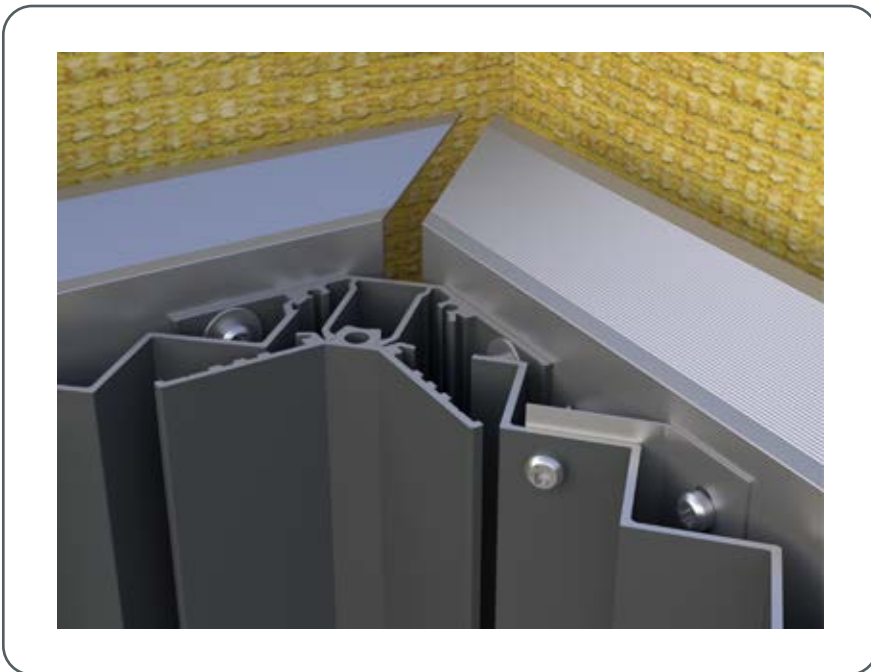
• Montaż bez zakleszczeń przyciętych profili
